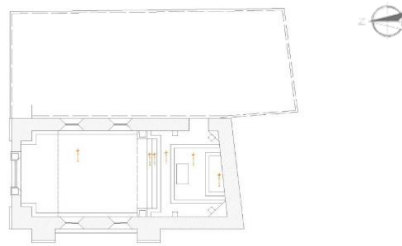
Planta arquitectónica de la Capilla de Nuestro Señor del Calvario. Estado actual. (Sánchez, G. 2018)
